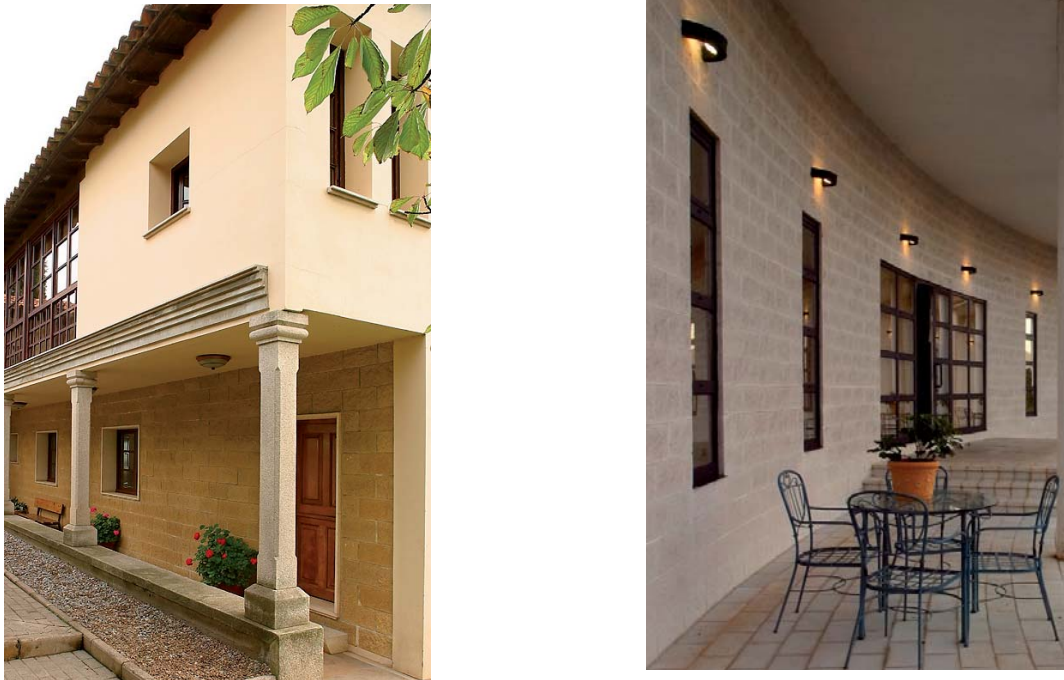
Viviendas con mampostería estructural con bloque de hormigón enfoscado.
